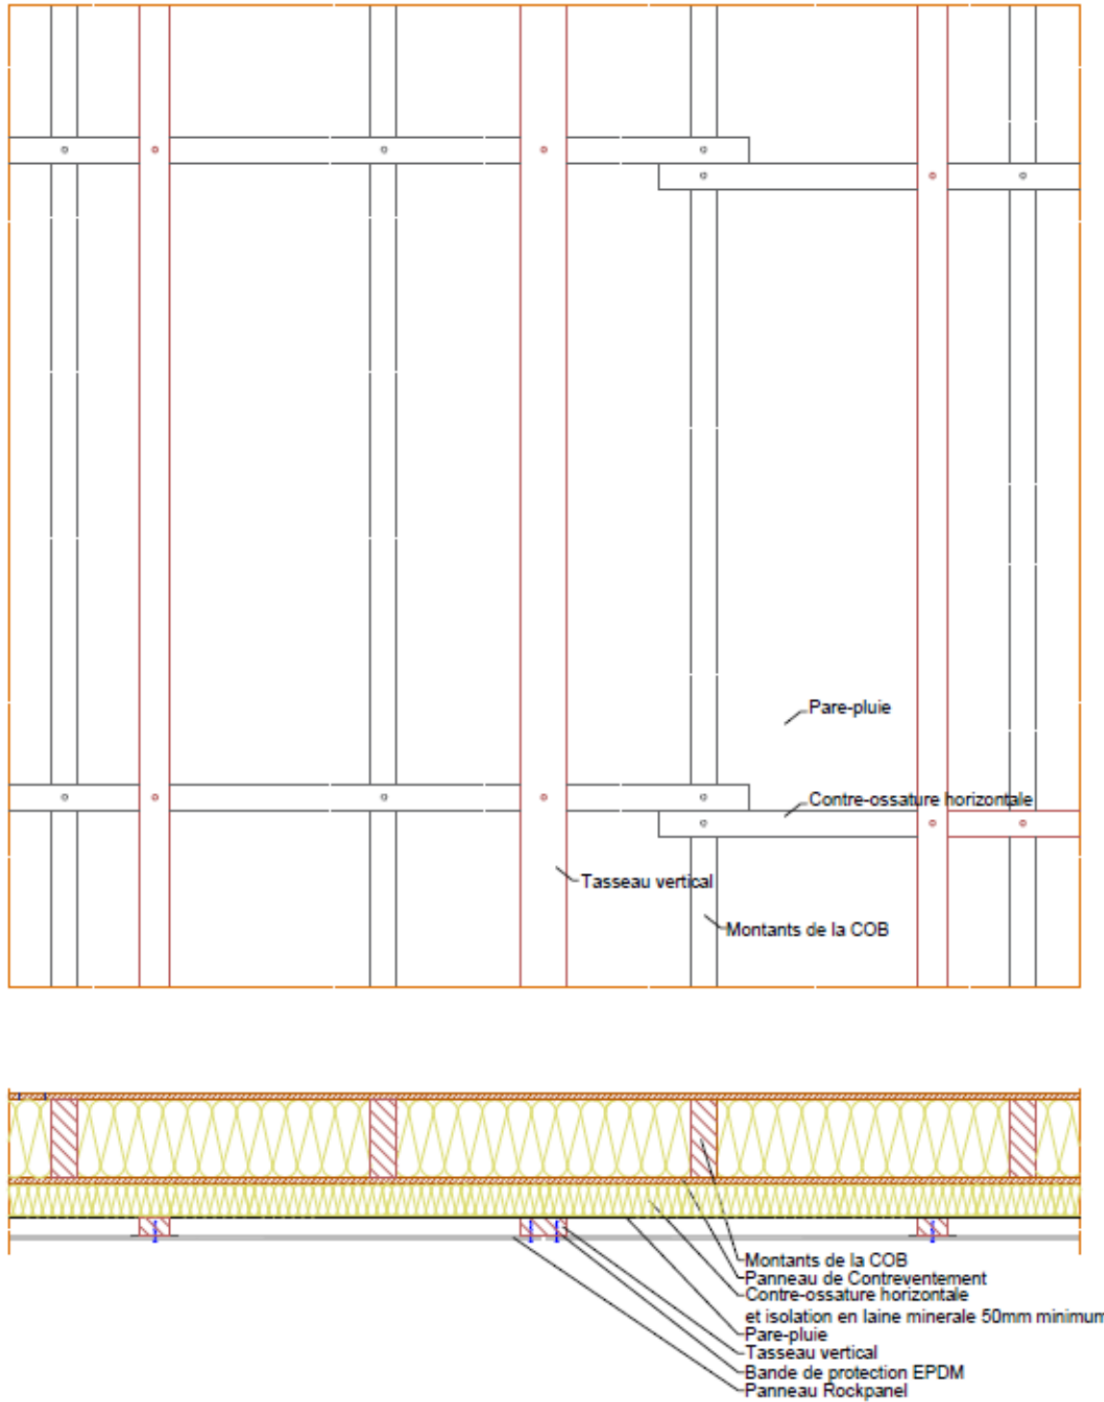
Exemple de bande PVC ou EPDM sur tasseaux pour bande de protection
